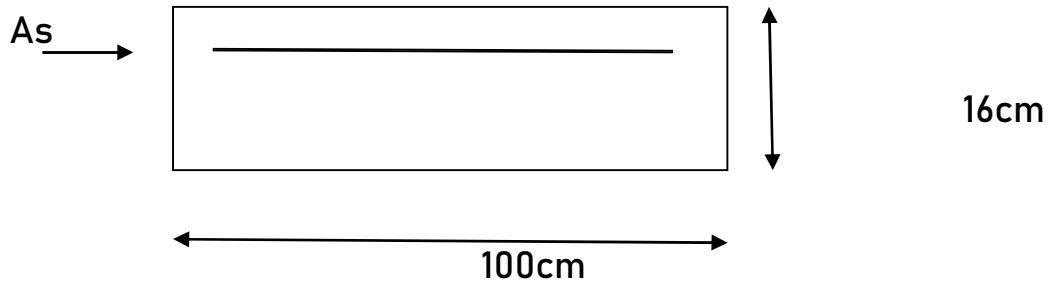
Coupe transversale d'un mètre linéaire du balcon.
